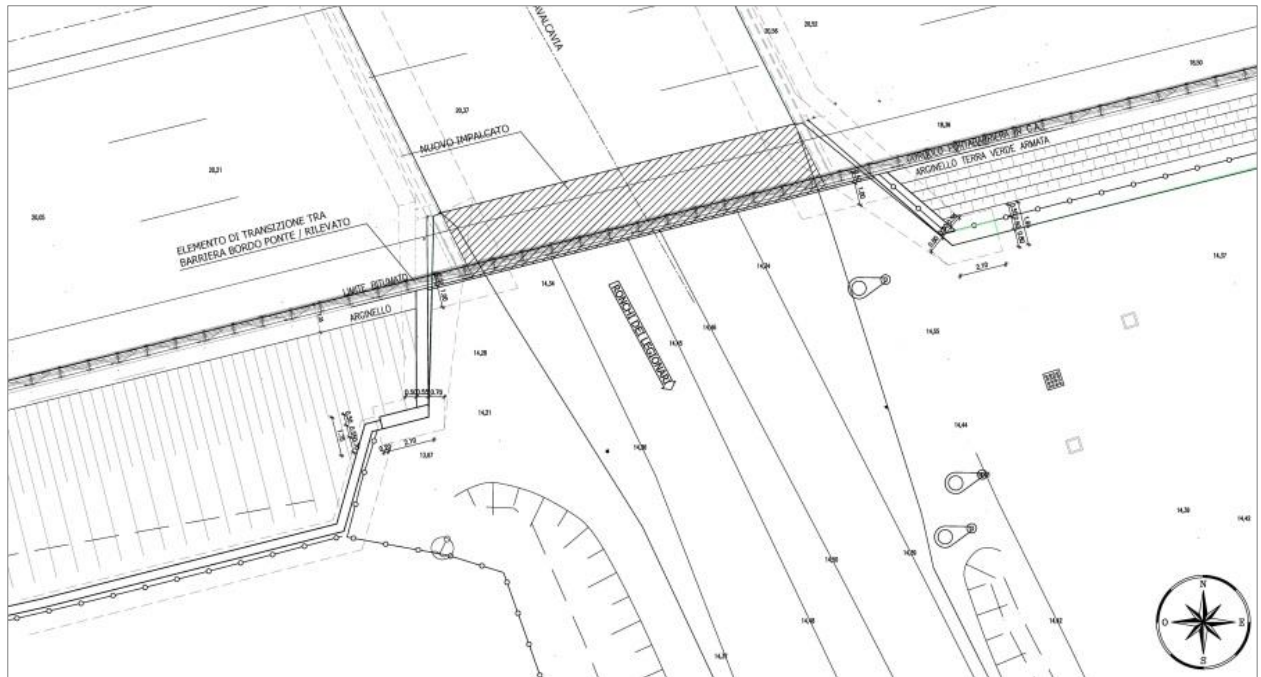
Dettaglio planimetrico dell'allargamento dell'impalcato sul cavalcavia della SS.305.
